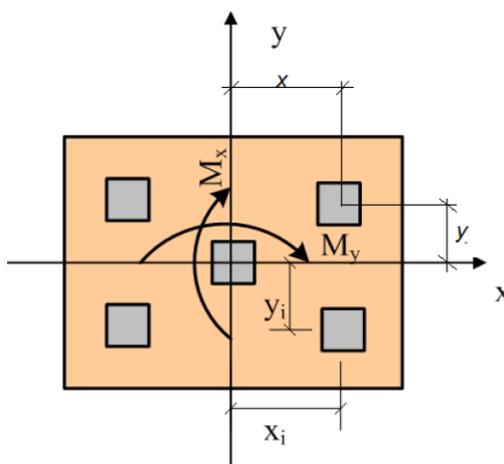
Расчетная схема для определения нагрузки на наиболее нагруженную сваю
